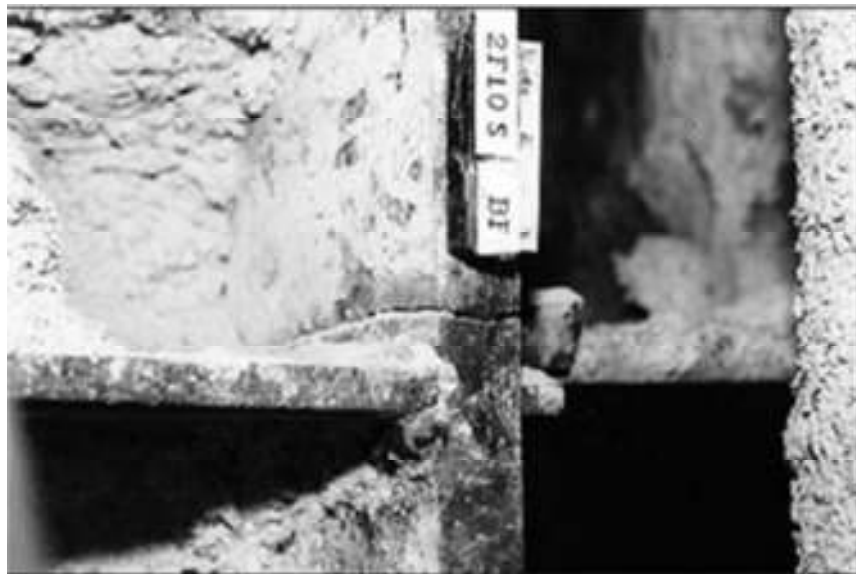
Típica falla frágil en conexión viga-columna "Pre-Northridge" (Alacero, 2008)
